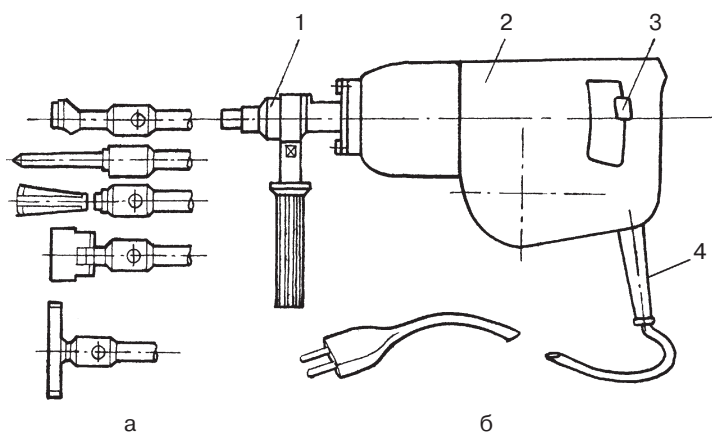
Электромагнитный фугальный молоток марки ИЭ 4207: а — сменные насадки; б — общий вид
